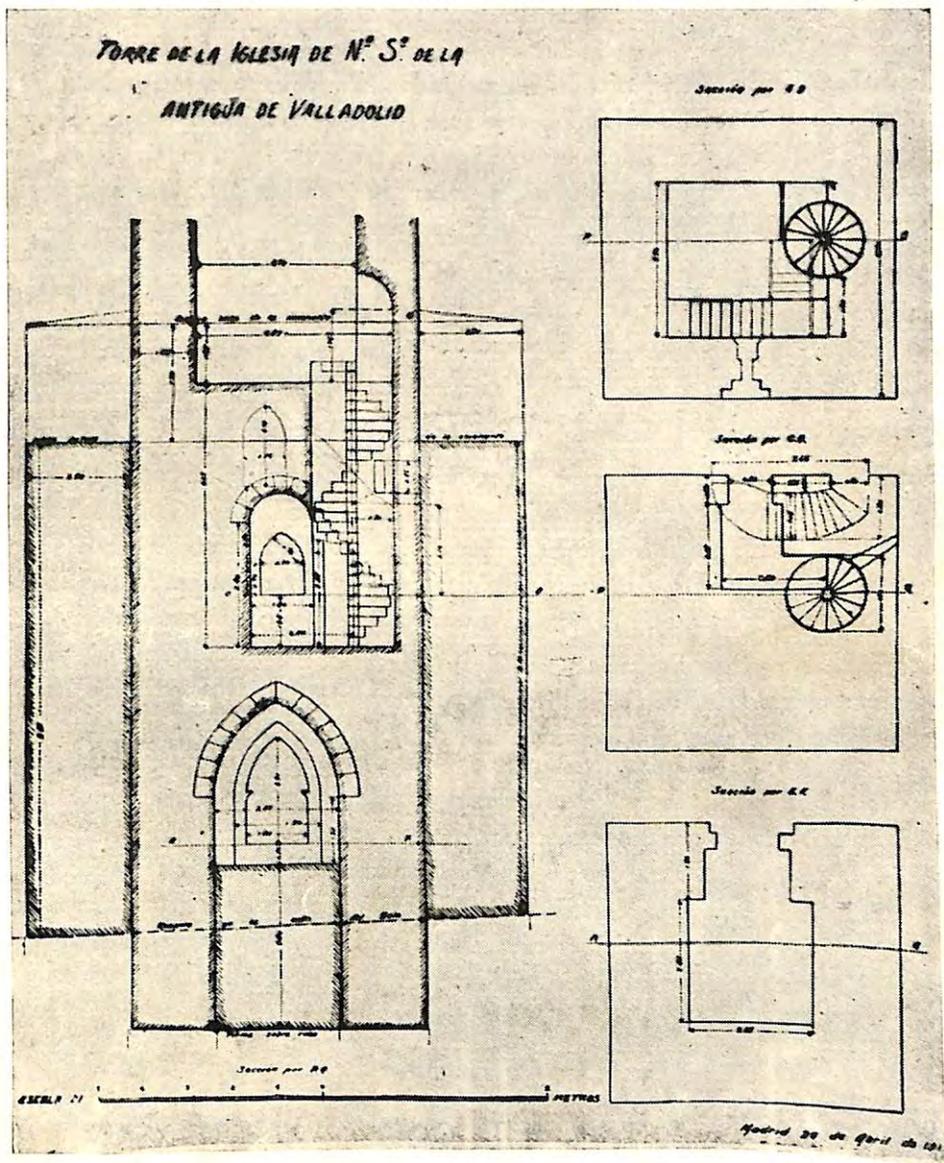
<sup>a</sup>—Corte longitudinal y planta de la torre, según Fernández Casanova.
